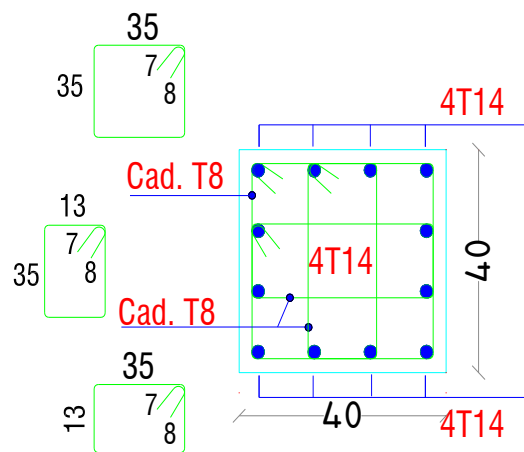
coupe Ferraillage des poteaux (40×40) cm<sup>2</sup>.
